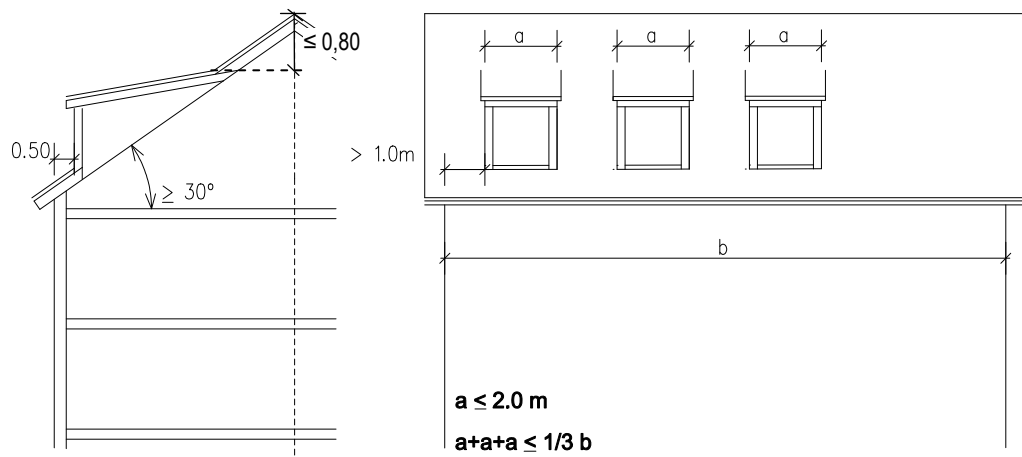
Anordnung und Abmessung von Dachaufbauten
